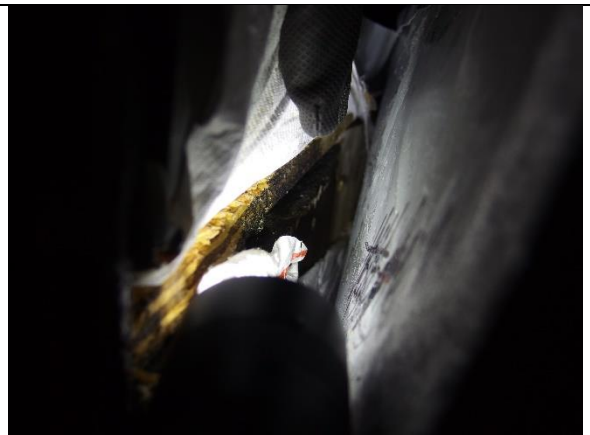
Feil i vindtettsjikk mv. parapet (Årvollveien 70).
